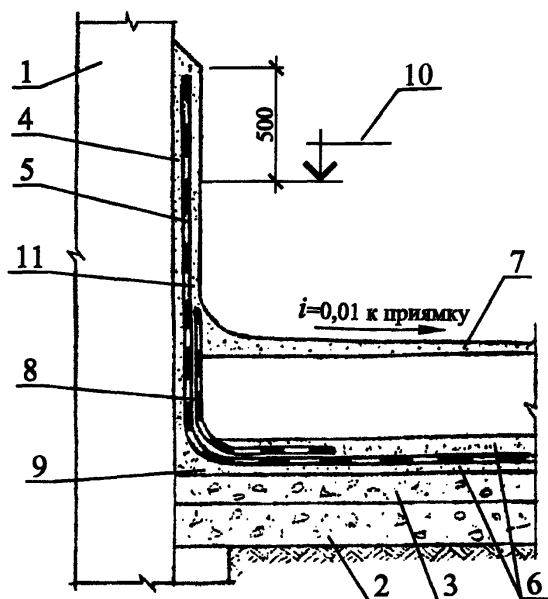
Гидроизоляция реконструируемых подвалов по грунту, при уровне грунтовых вод от 15 до 50 см
